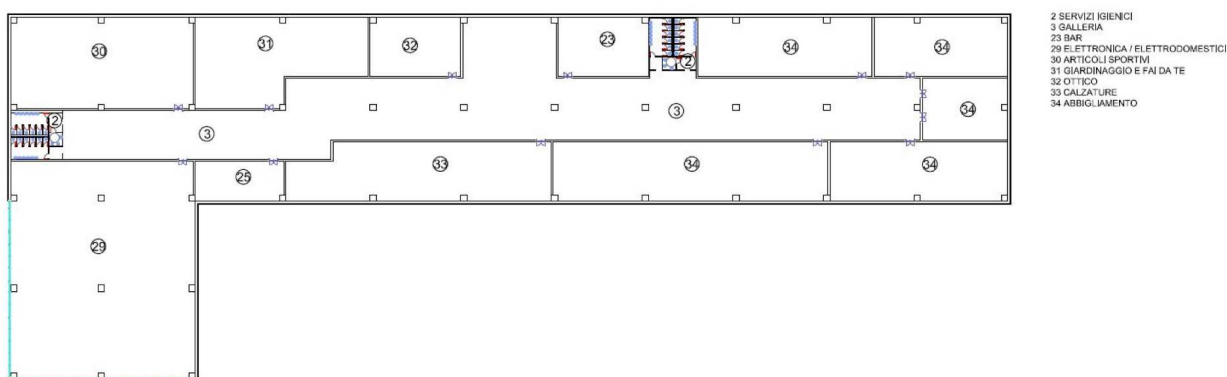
Pianta interna secondo piano arredata IperCoop Center
